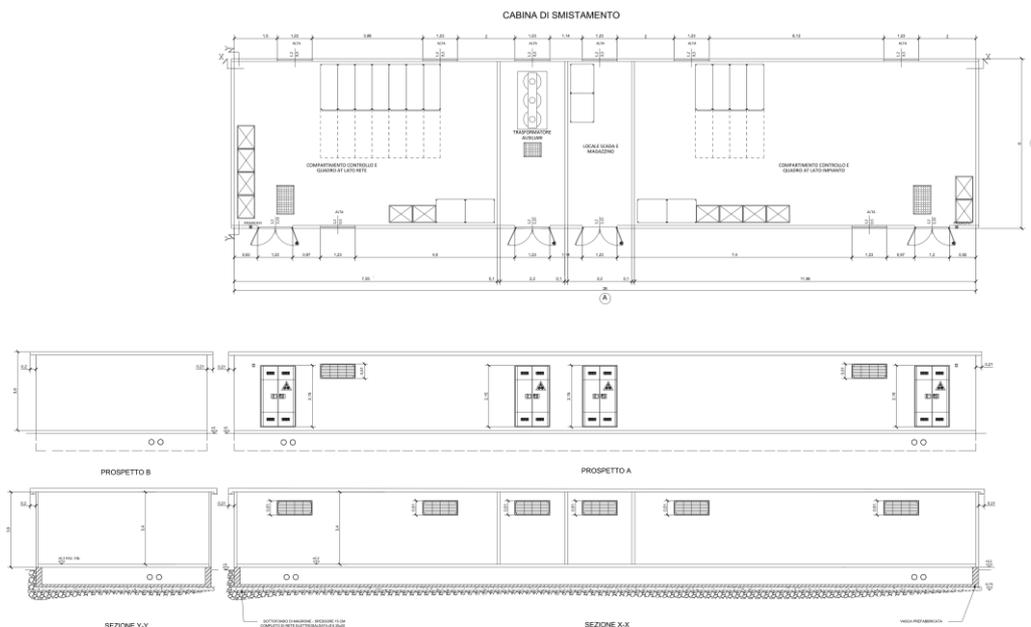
Cabina AT di smistamento - Vista in pianta e prospetto
